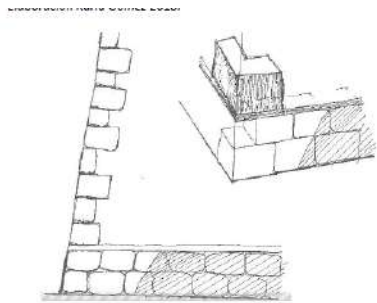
muro de sillares de piedra aparejada y sillares de esquina. Fachada norte fortificación militar sisal Yucatán. Elaboración Karla Gómez 2018
